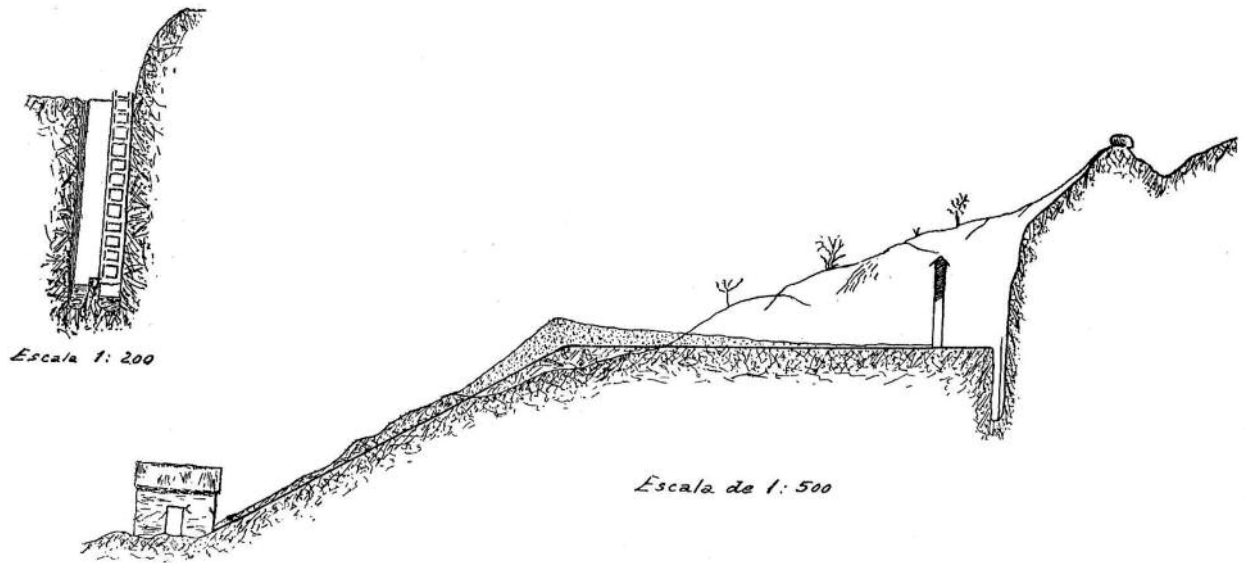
Planta del establecimiento de La Fe publicado en la Estadística Minera de 1911.
